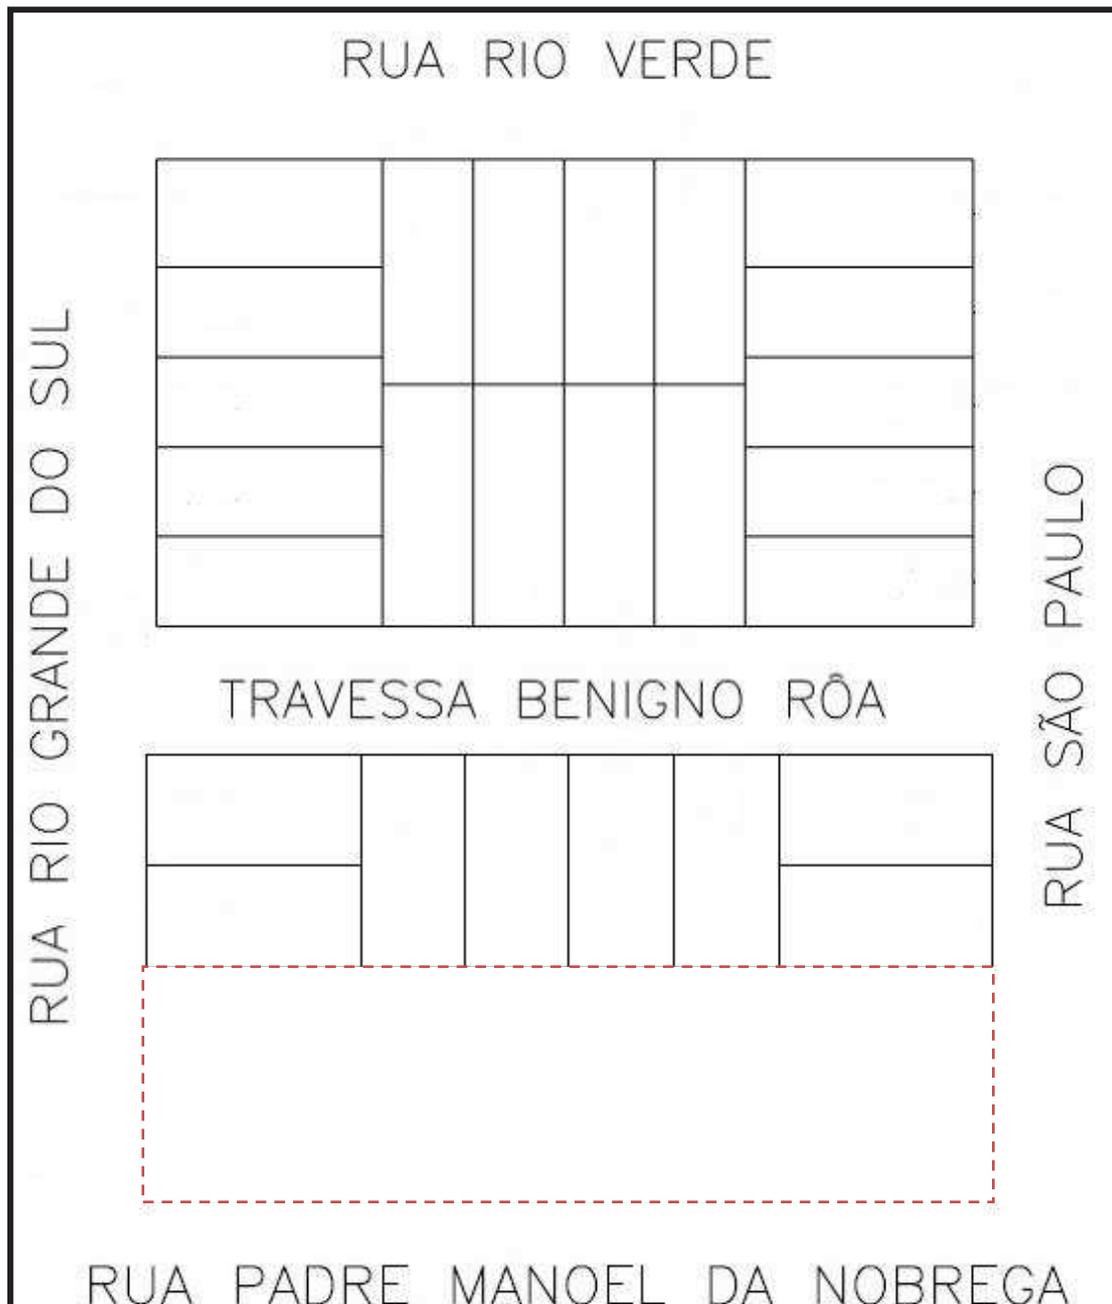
Planta baixa das quadras do local 01. FONTE: Junior Cesar Felix.
